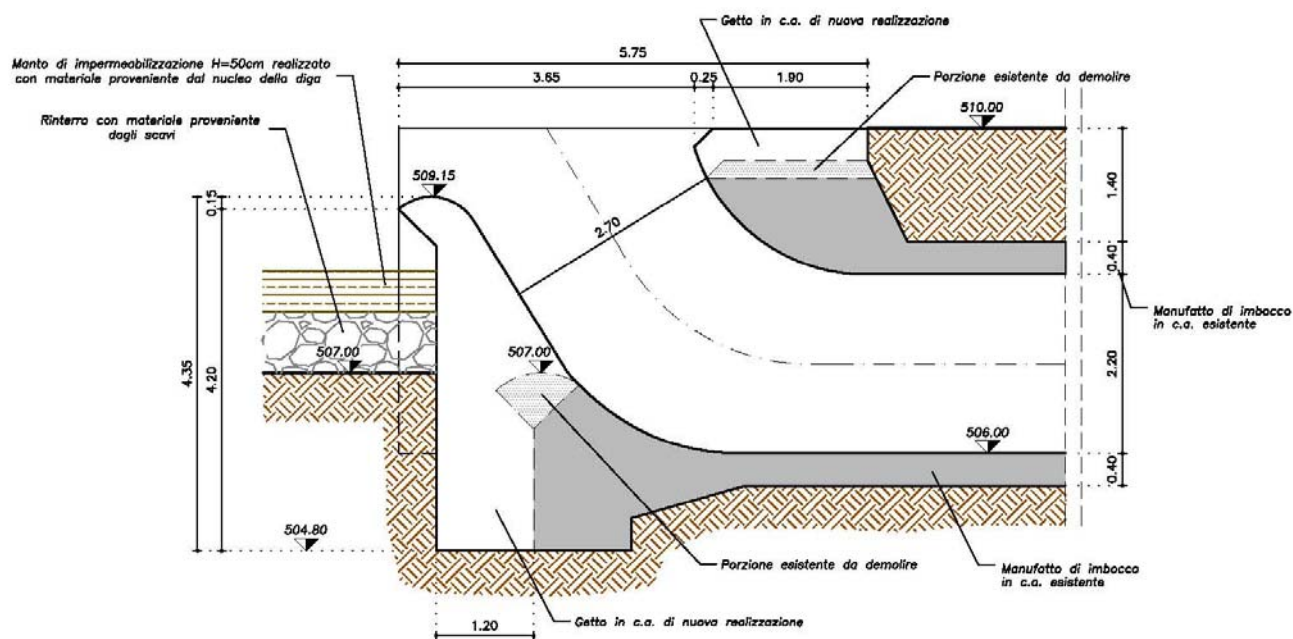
Sezione dell'imbocco dello scarico di fondo
